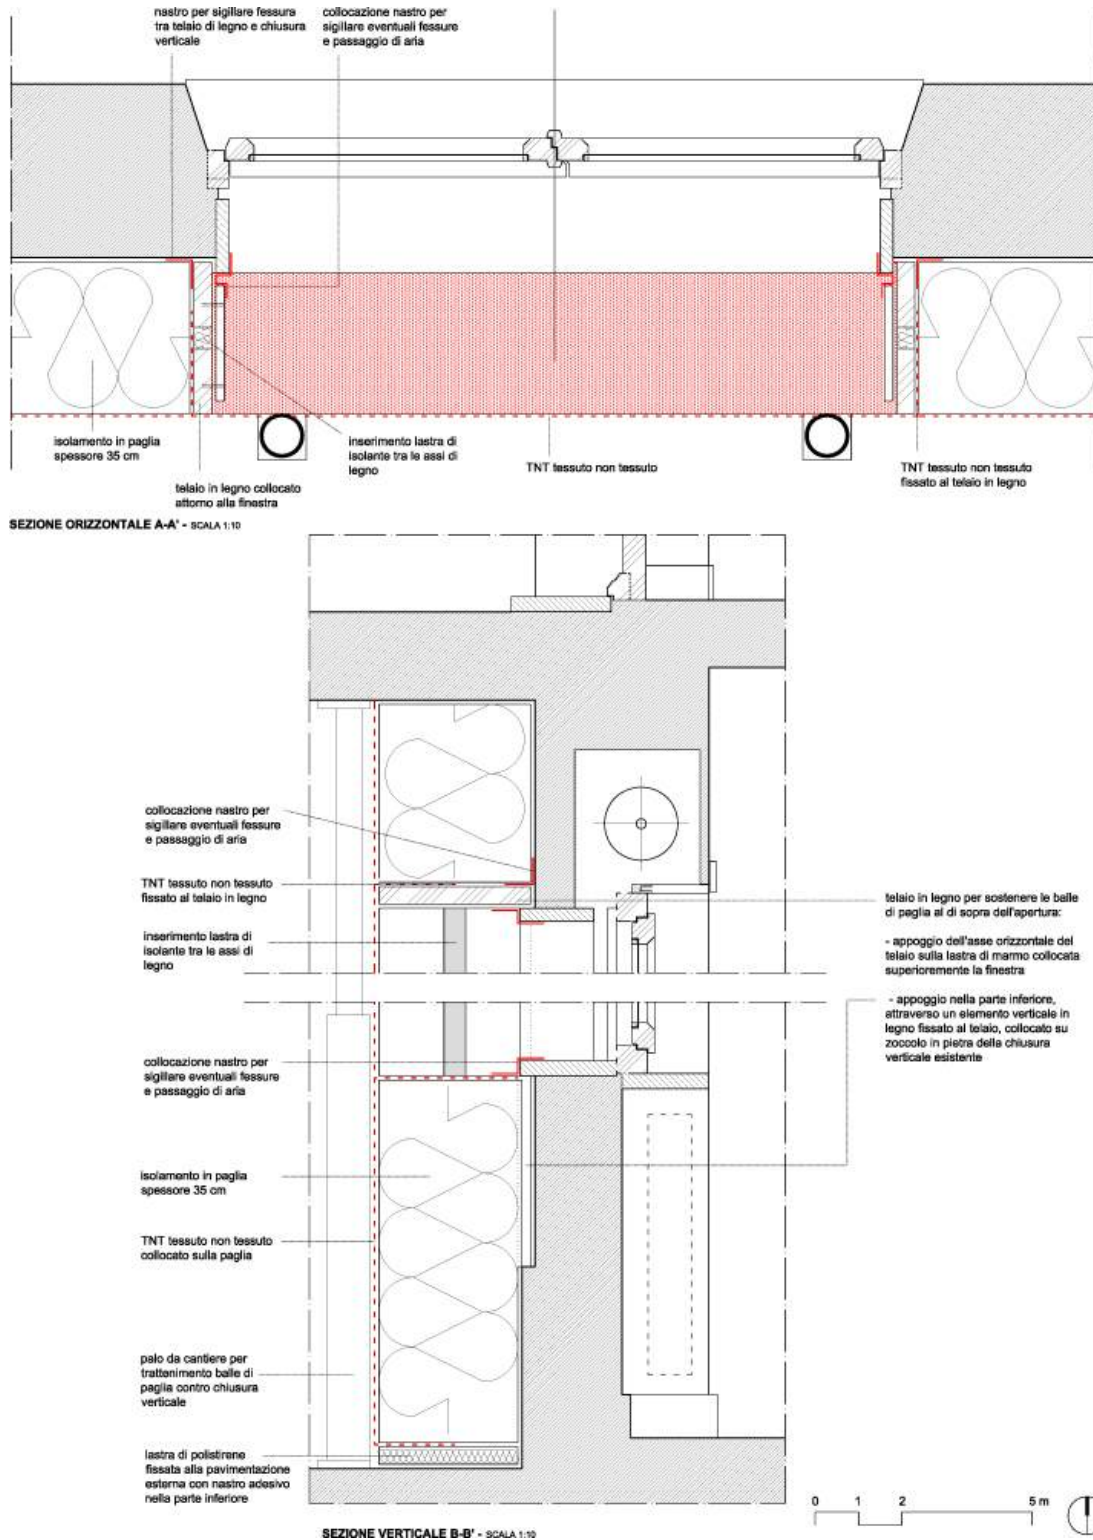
Pianta e prospetto del dettaglio in prossimità dell'apertura (fuori scala). Si veda tavola 9 nell'allegato *Disegni progettuali sperimentazione* (A.R. Bertorello, 13.12.13)
